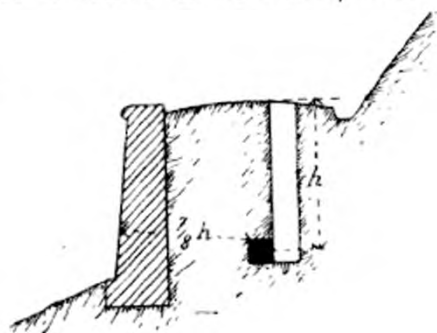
Coupure d'une route à flanc de coteau avec mur de soutènement.
